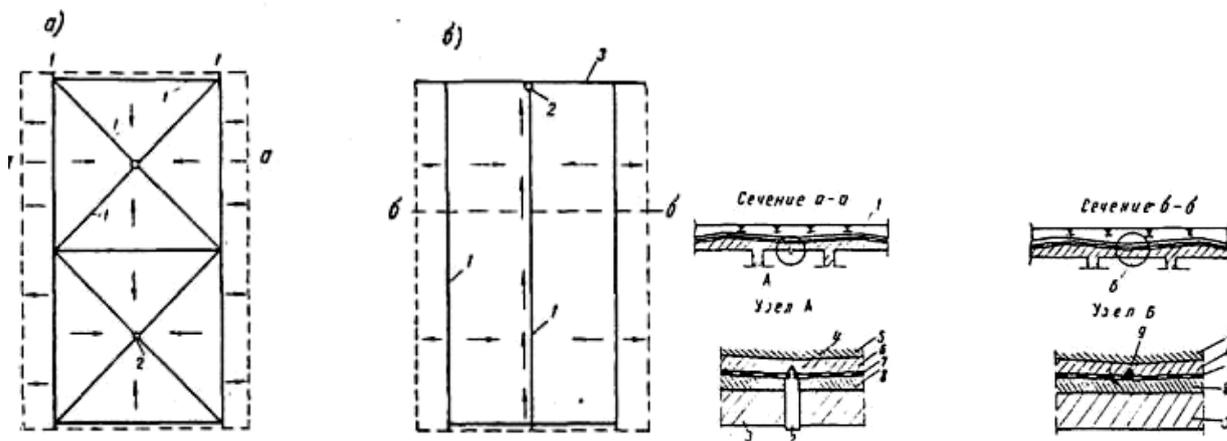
Схема отвода воды из-под трамвайных путей: 1-линии перелома профиля гидроизоляции; 2-трубка для отвода фильтрата; 3-плита проезжей части; 4-отверстие в гидроизоляции; 5-бетон подрельсового основания; 6-защитный слой; 7-гидроизоляция; 8-подготовительный слой; 9-дренаж [77]
